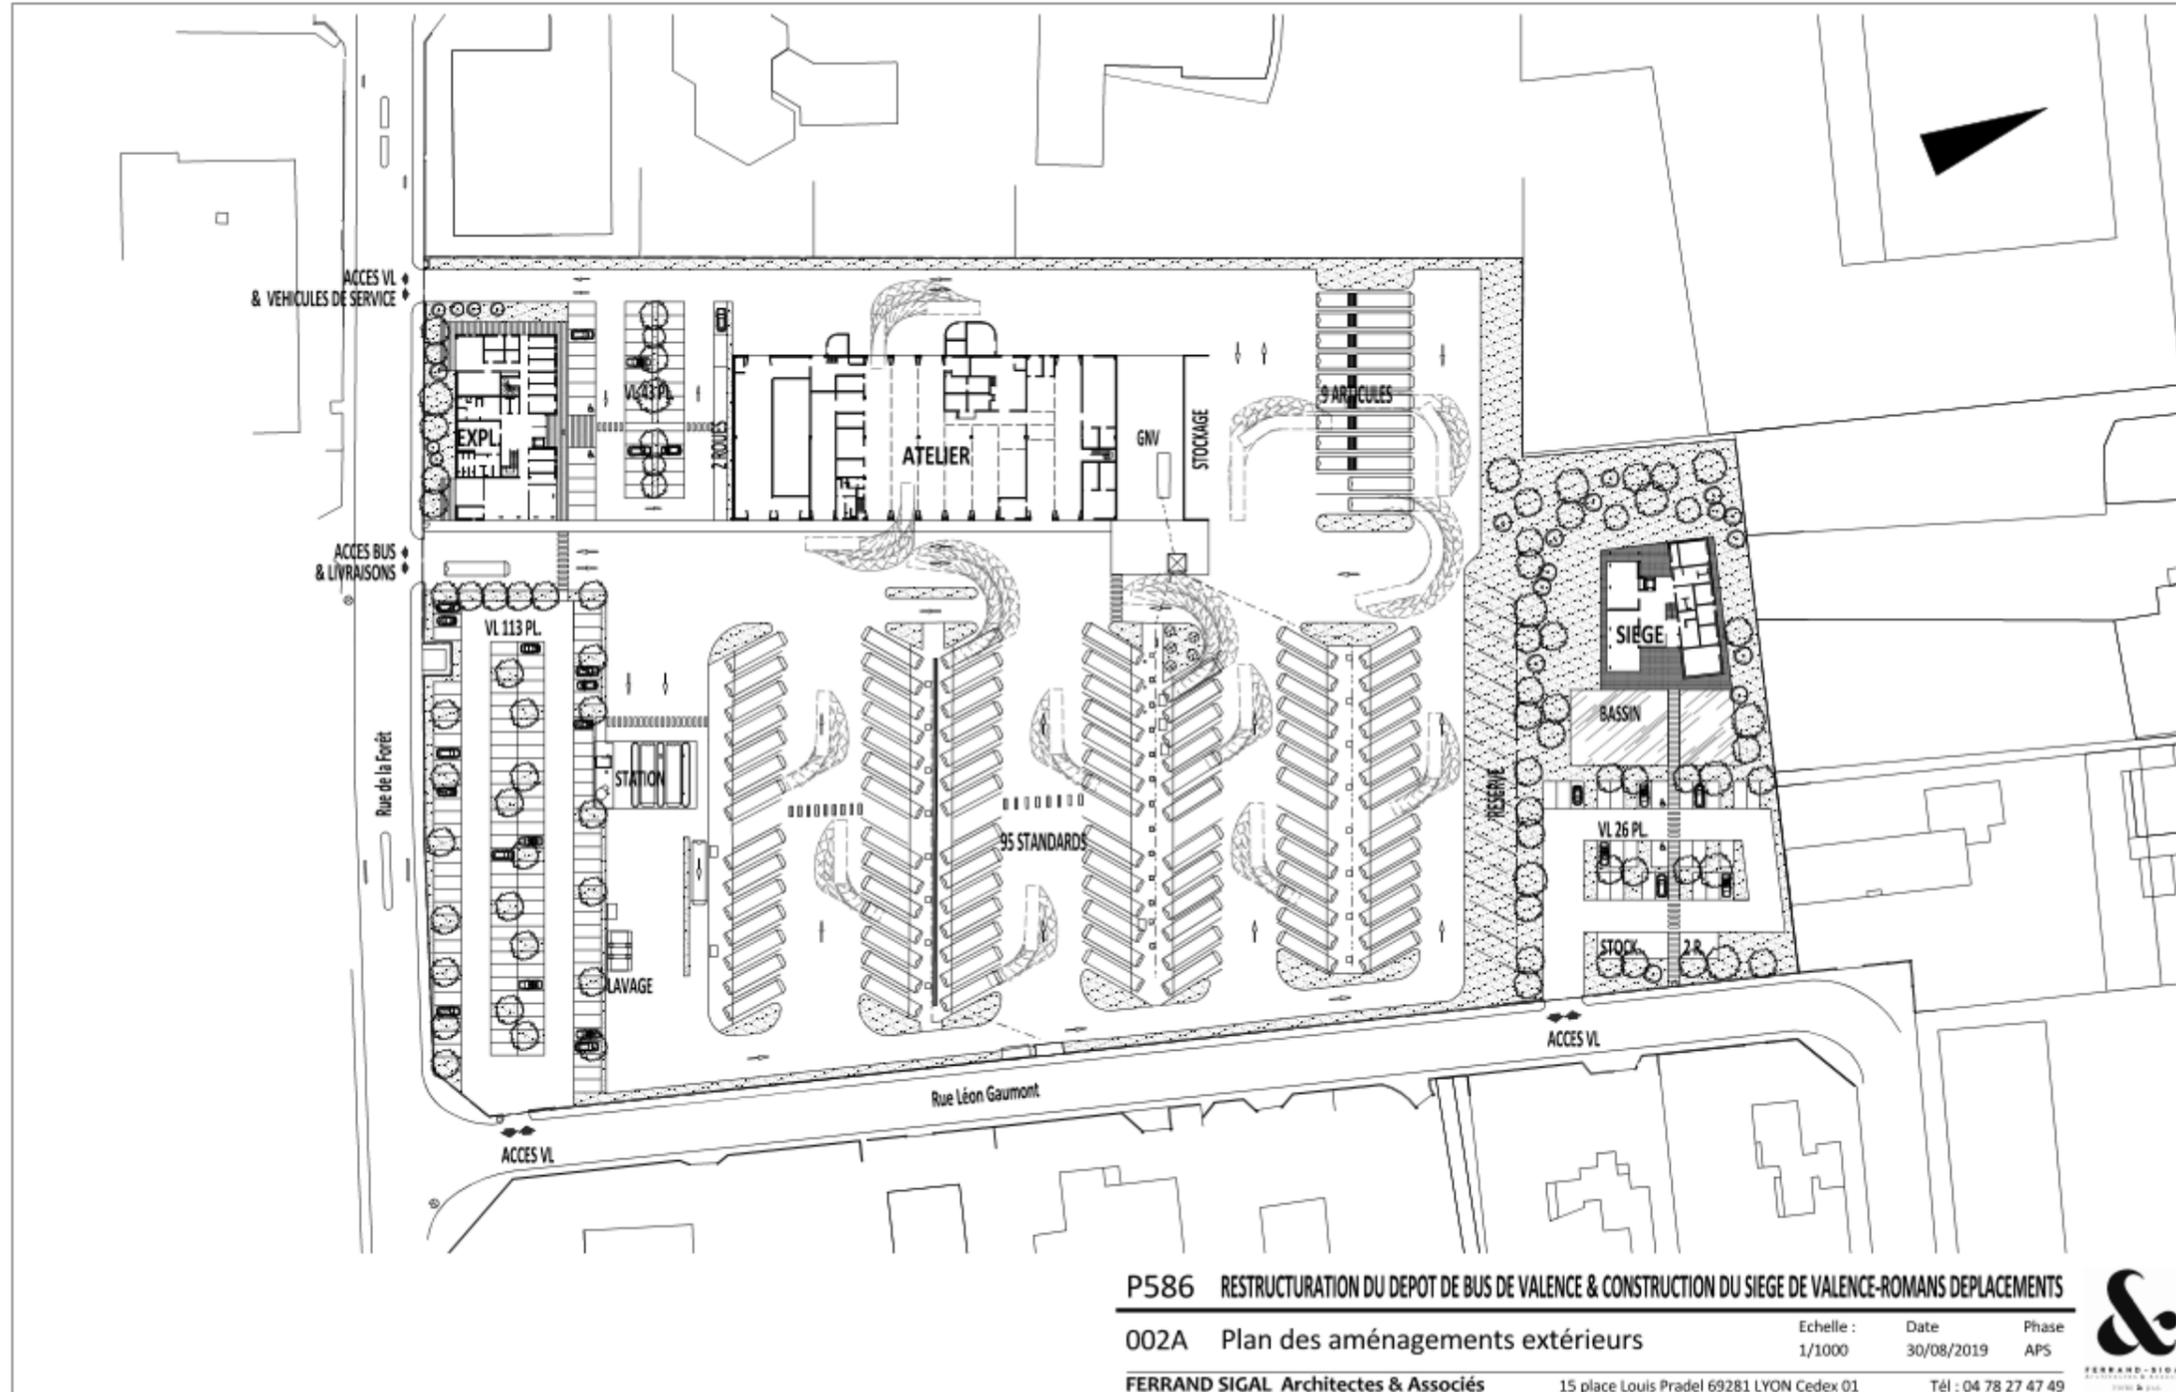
Plan masse (Ferrand-Sigal, 2019)
